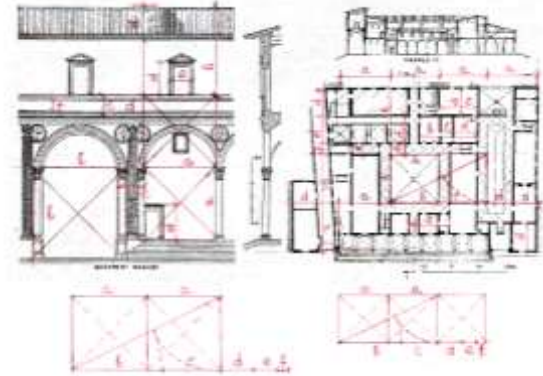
Пропорции «золотого ряда» в плане и на фасаде Воспитательного дома. Арх. Ф. Брунеллески, 1419 – 1445 гг.
